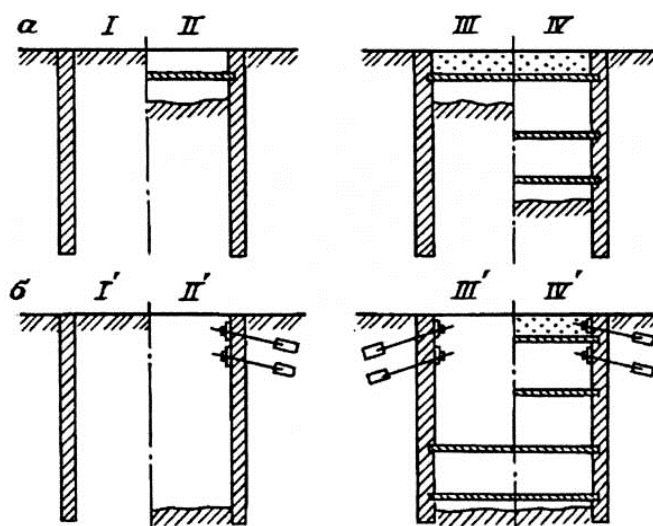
Будівництві багатоярусних підземних споруд: а, I – зведення несучих стін; II – розтин котловану і зведення верхнього перекриття; III – зворотна засипка; IV – розробка ґрунту і зведення між'ярусних перекриттів; б, I', II' – розробка ґрунту на проектну глибину котловану і закріплення стін; III' – зведення між'ярусного перекриття; IV' – засипання котловану та відновлення поверхні
